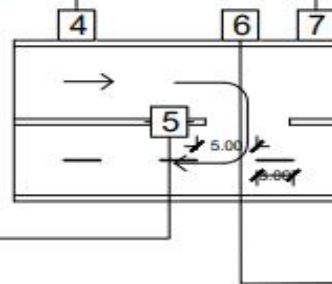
Potongan Site Plan Titik Lokasi Rambu
